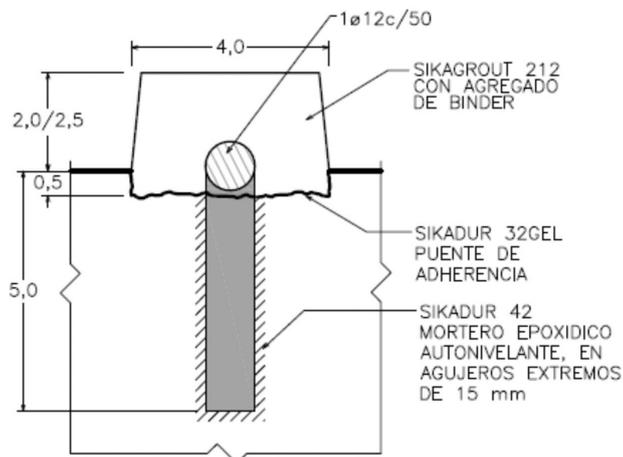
(c) Detalle de las armaduras adicionadas, anclaje de la barra y material agregado.
